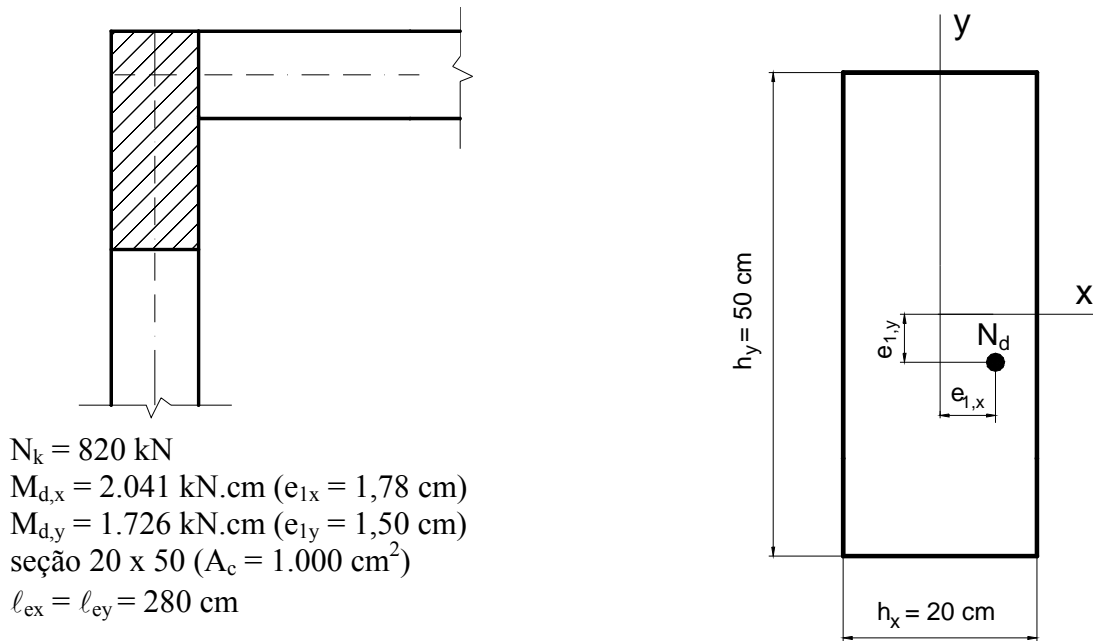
Arranjo estrutural do pilar na planta de fôrma e dimensões da seção.
